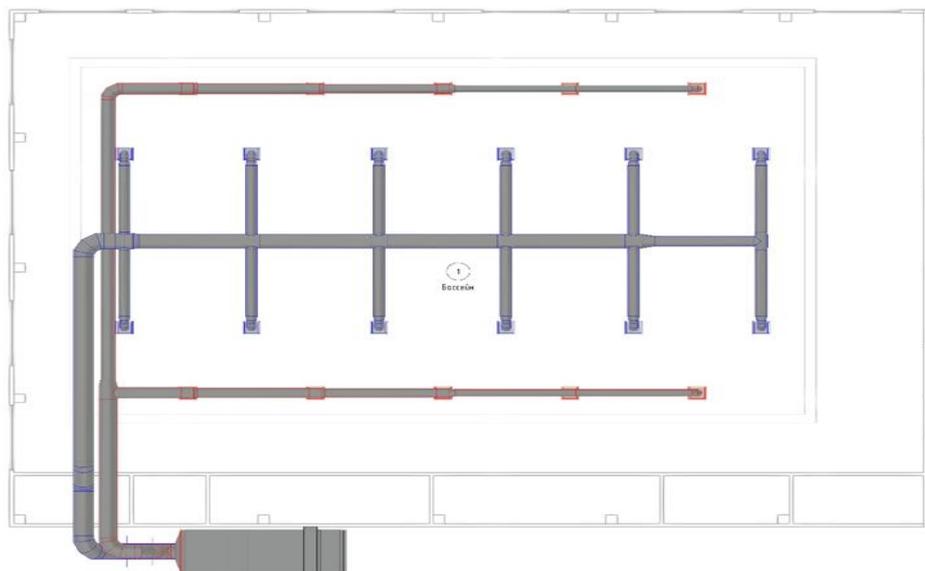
План с нанесение элементов системы кондиционирования при схеме смешиванием.
